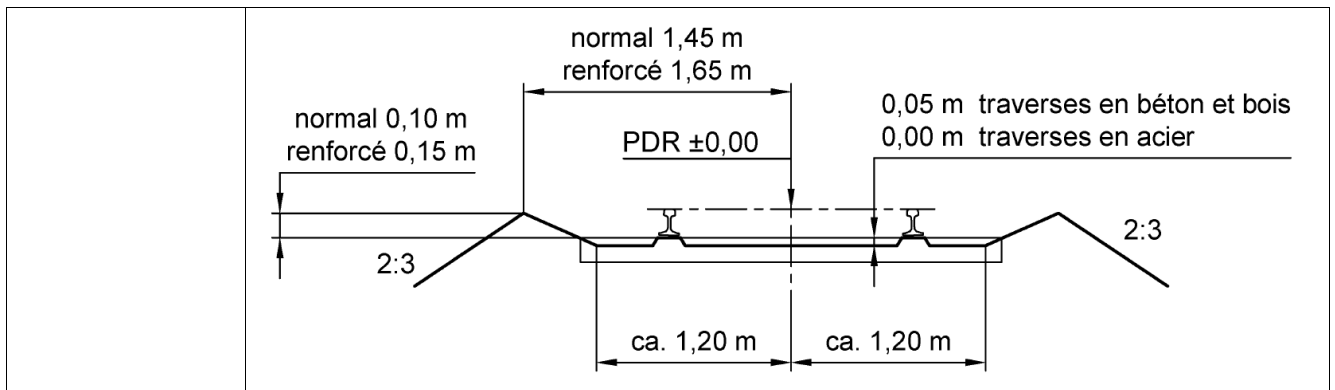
Profil du lit de ballast abaissé (voie normale).
